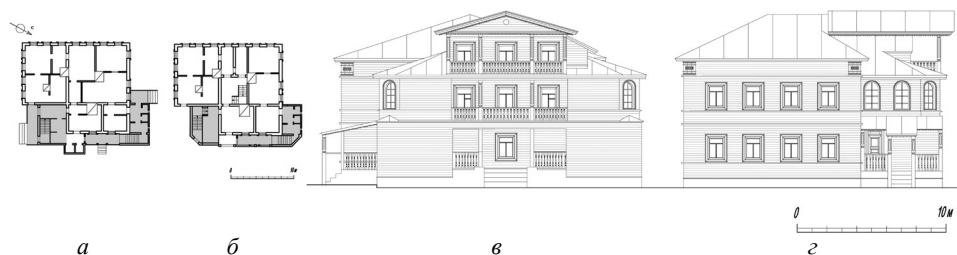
Дом по ул. Варенцовой, 1: а – план 1-го этажа; б – план 2-го этажа; в – главный фасад; з – боковой фасад
